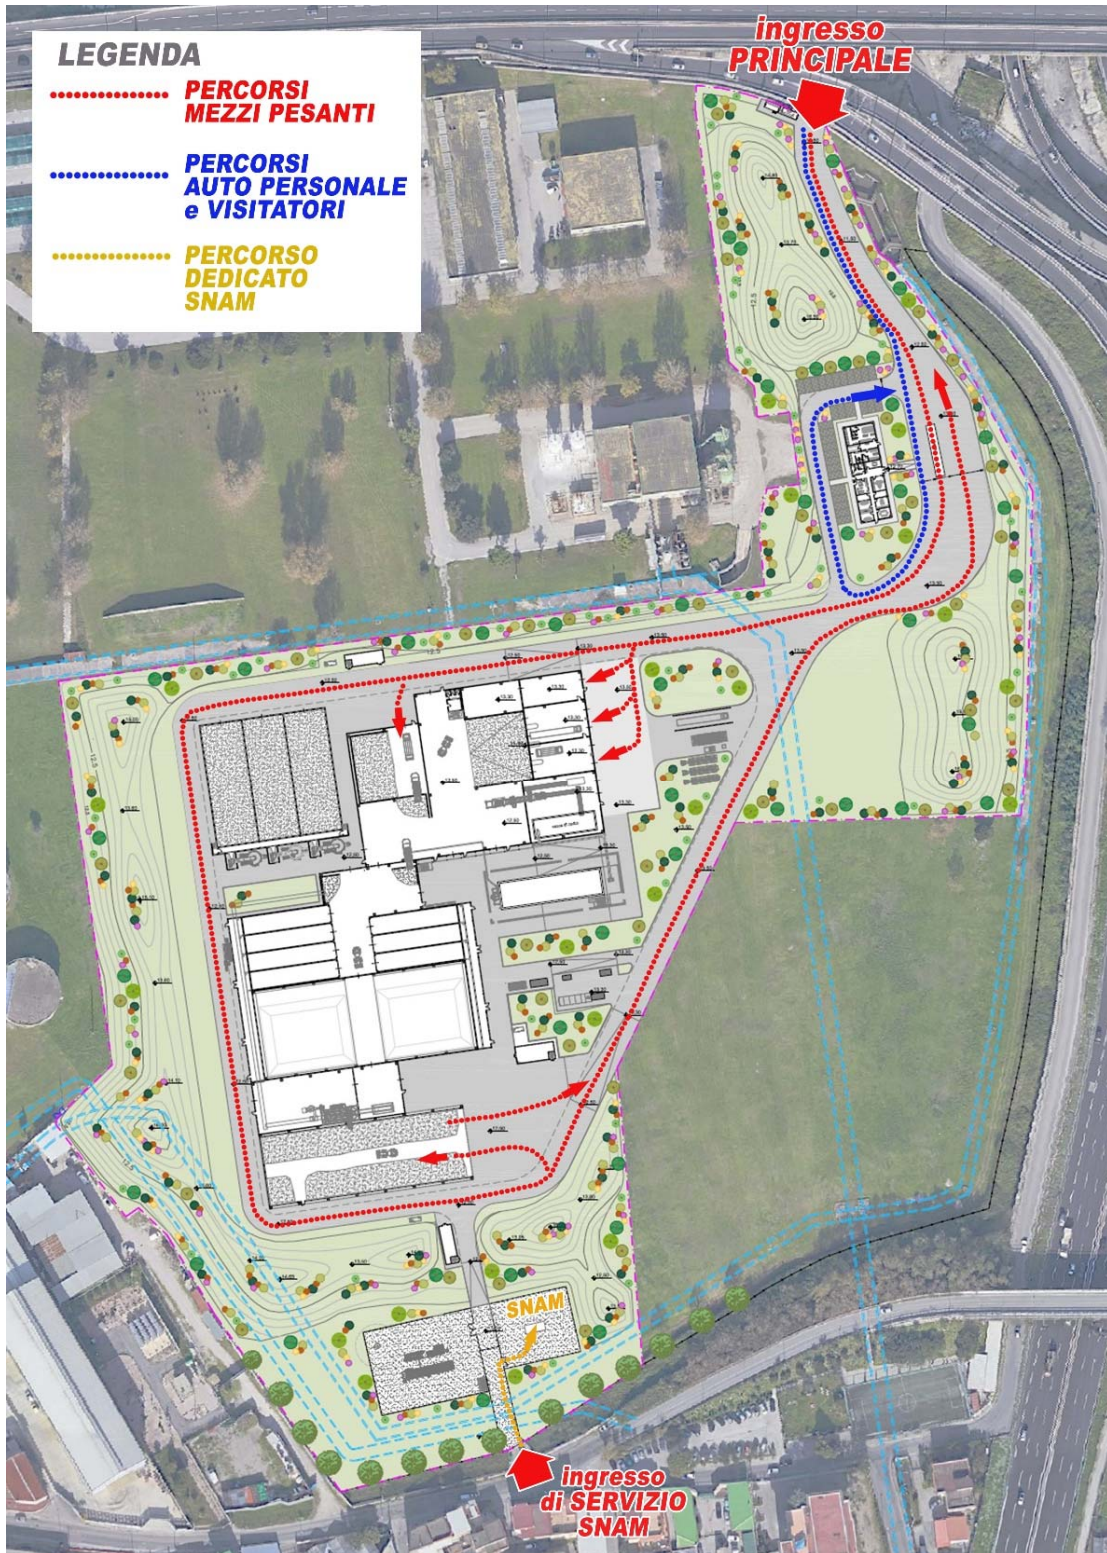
Planimetria con indicazione della viabilità interna all'impianto
